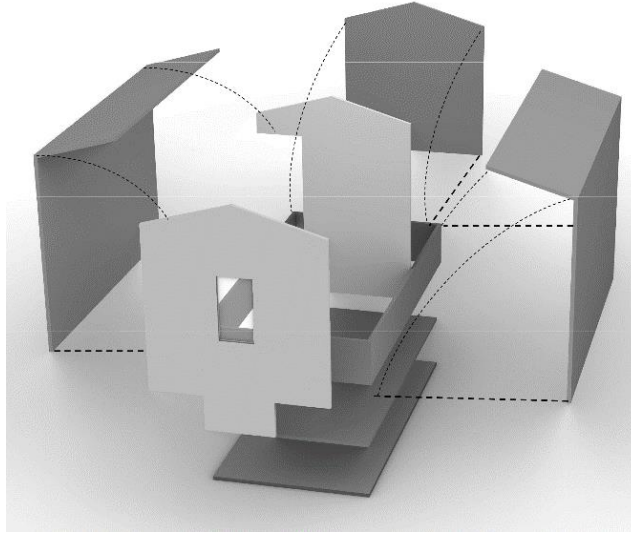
Planimetría módulo, distribución y orden, Rescue Center (Harrouk, 2020)
